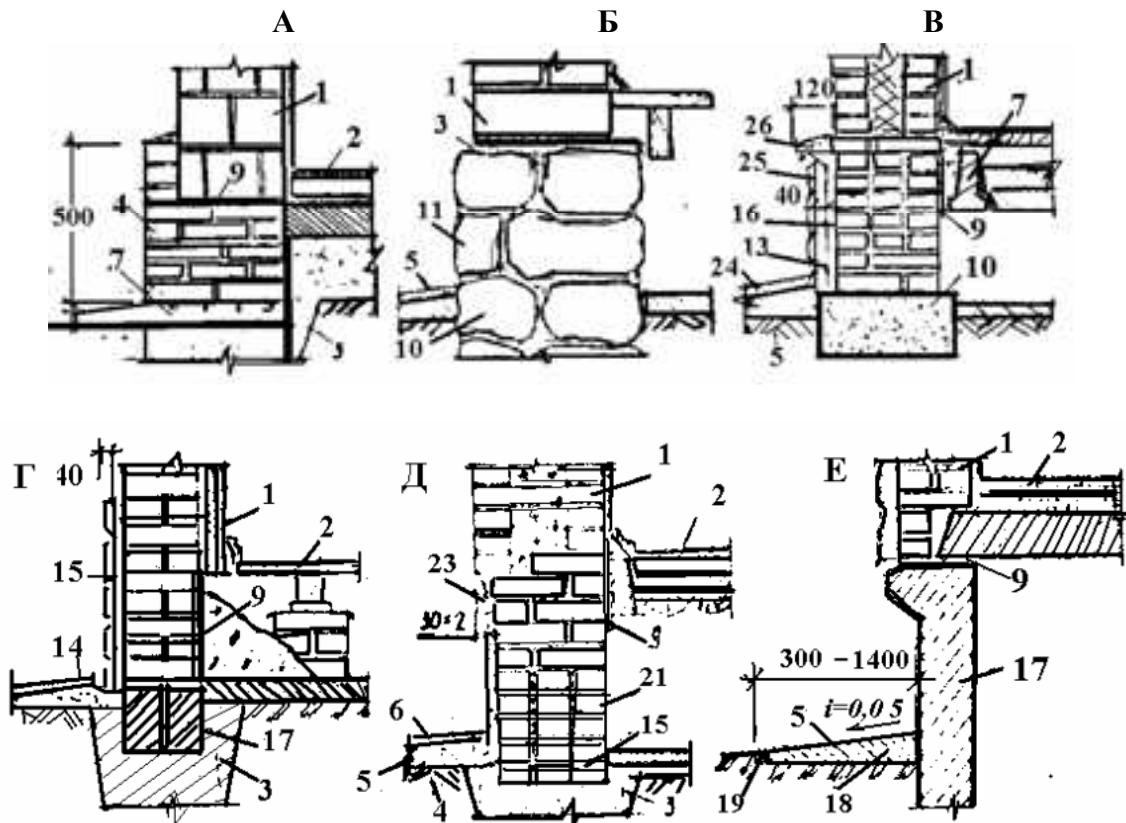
Схеми цоклів кам'яних стін малоповерхових будівель:
